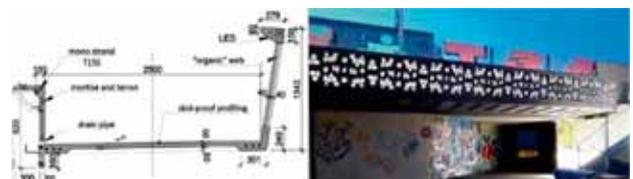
Пешеходный путепровод Martinet Bridge, г. Лозанна, Швейцария, 2015 г. Сооружение представляет собой разрезную однопролетную балку длиной 15,3 м с опиранием на устои в виде подпорных стен. Поперечное сечение несимметричное корытообразное. Предварительное напряжение обеспечено арматурными элементами из «монострендов», расположенными в углах нижней плиты (в вутах) и вверху стенок балки.
